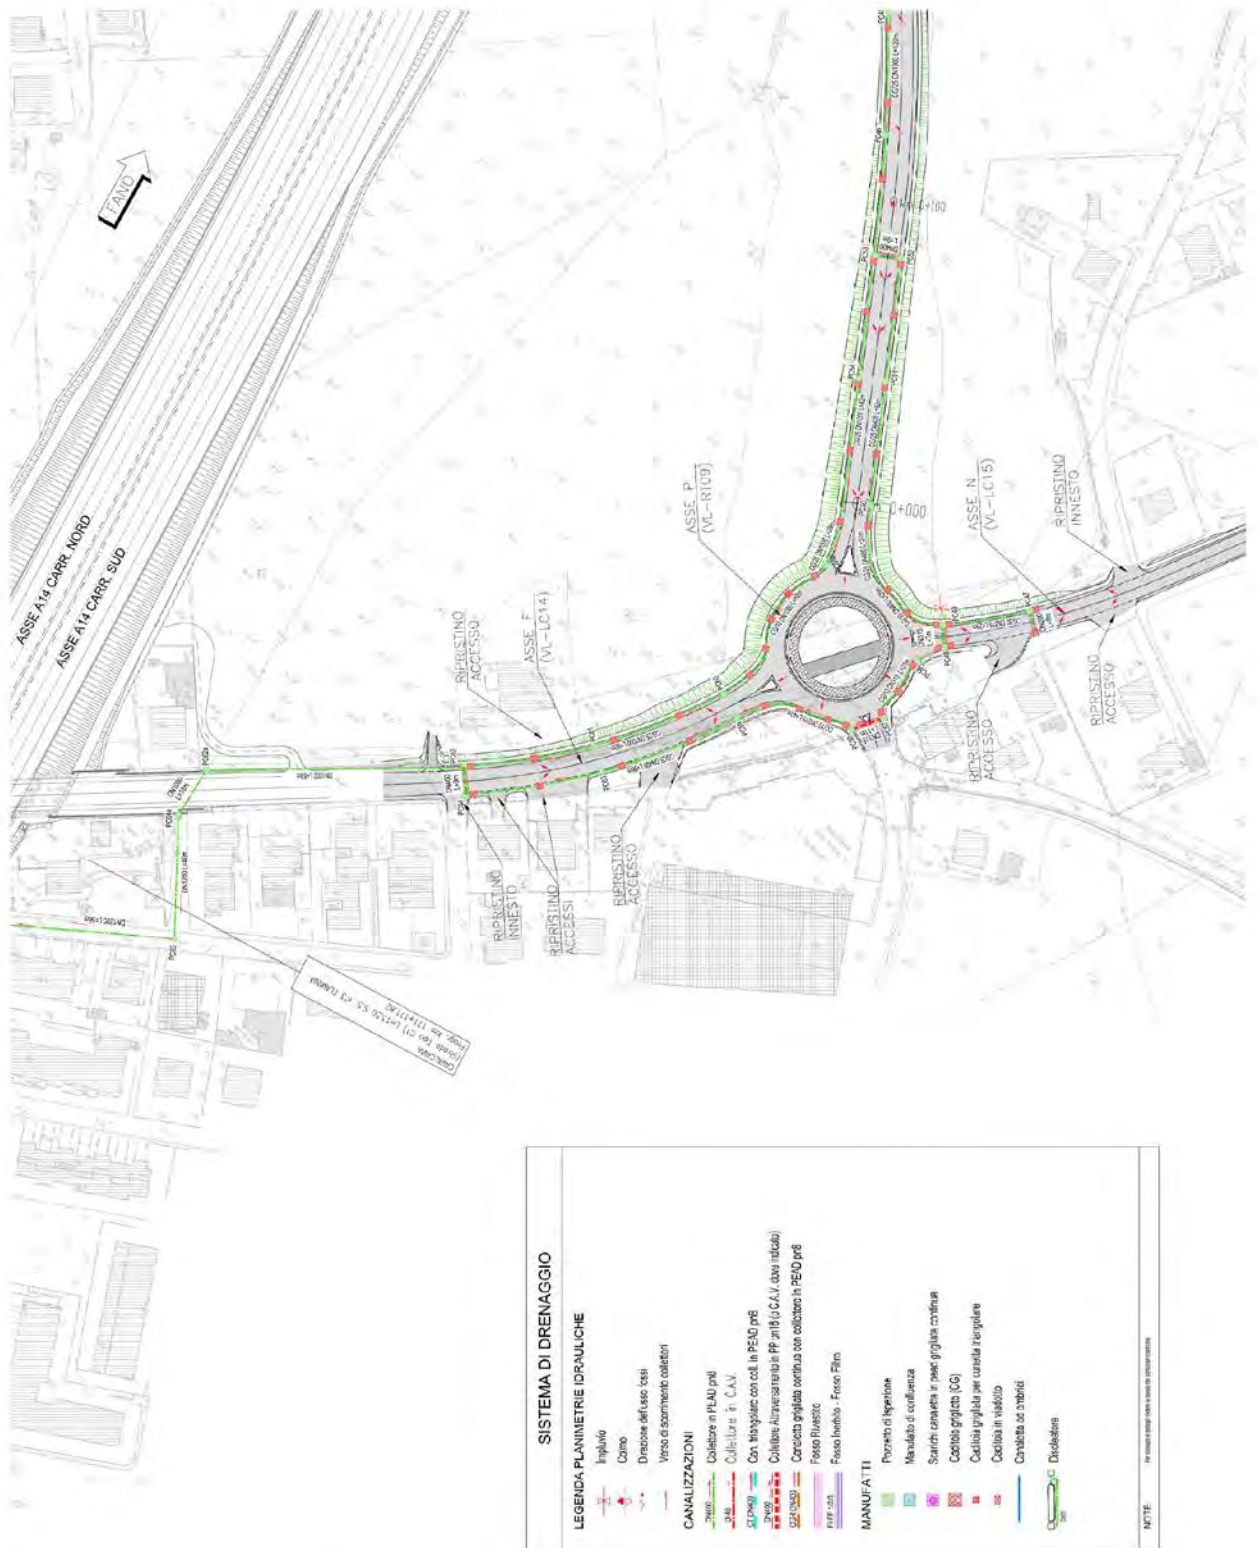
Stralcio planimetrico con schema rete di raccolta delle acque chiare realizzata dalla Soc. Autostrade in corrispondenza della rotonda di viale Moriconi in adiacenza all'area di intervento.
